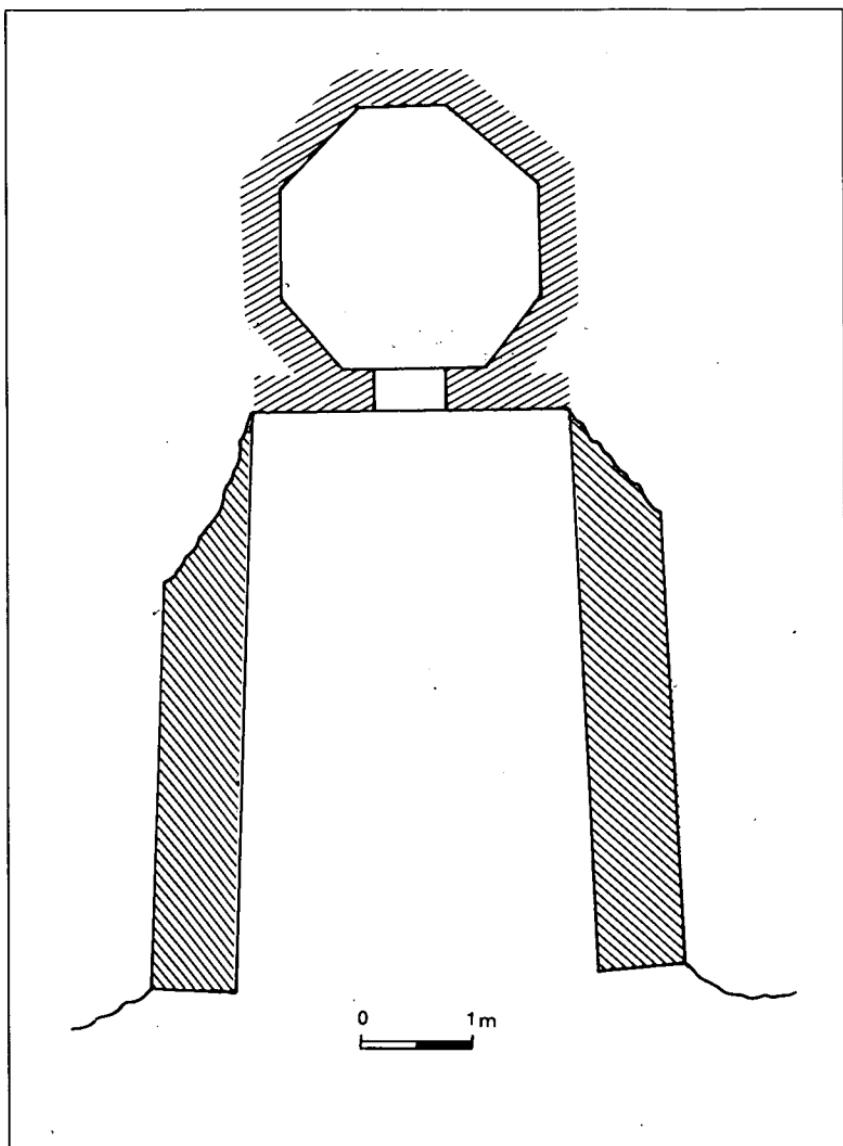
Manantial 'Ayn Talamara (Tazlat): plano de la construcción que protege el afloramiento.
